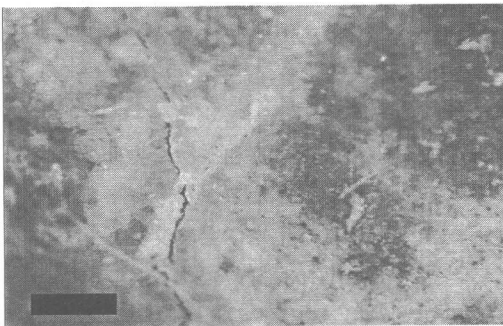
EC-2 ひび割れ発生後 29 日目
